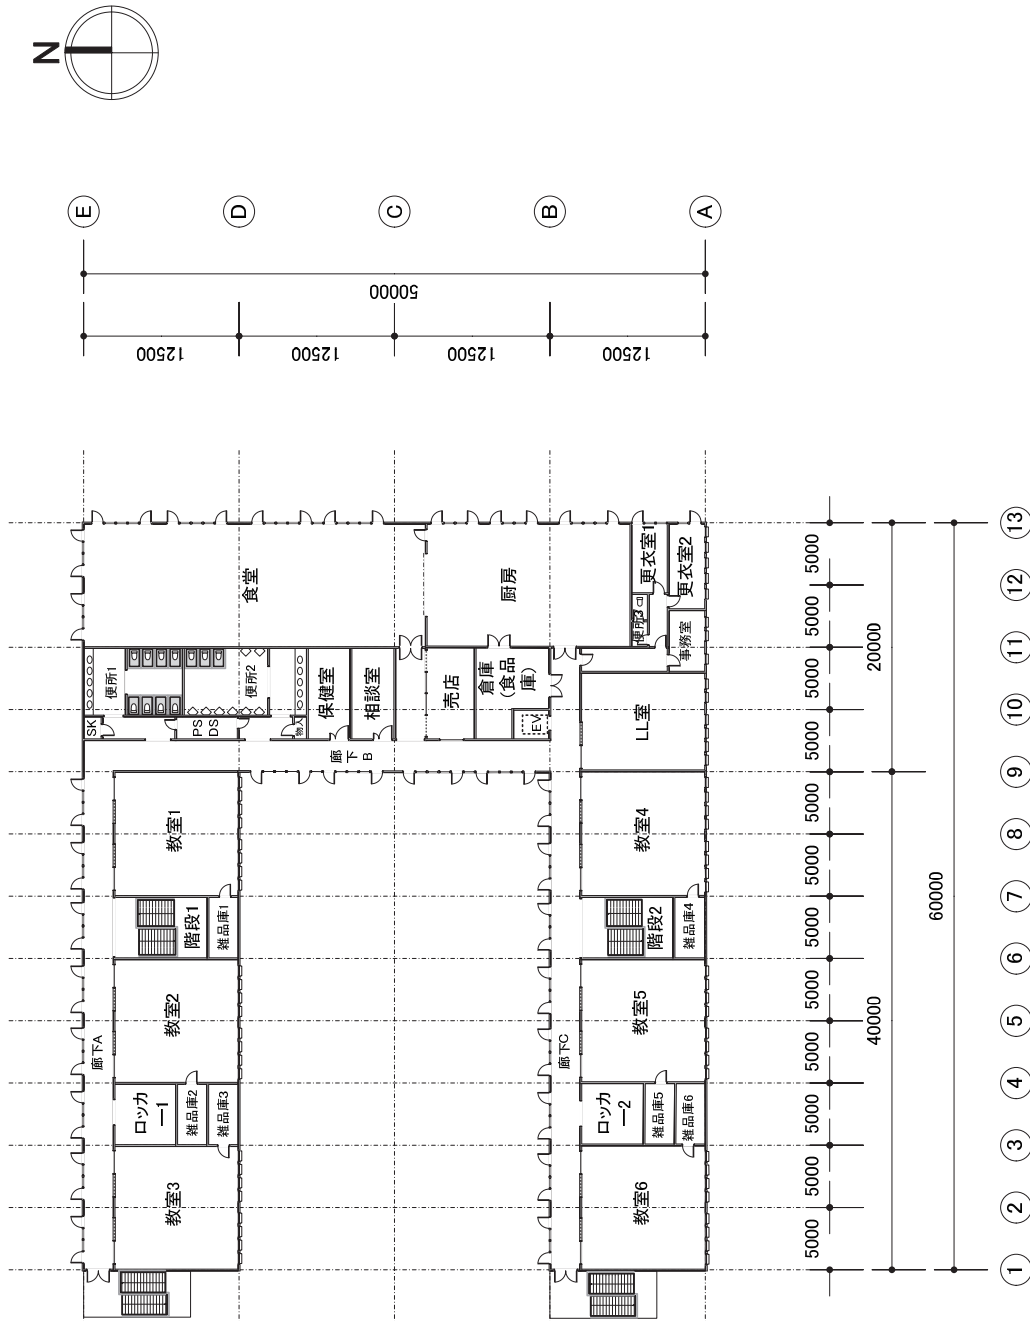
モデル建物（学校等、5,000㎡） 2階平面図
